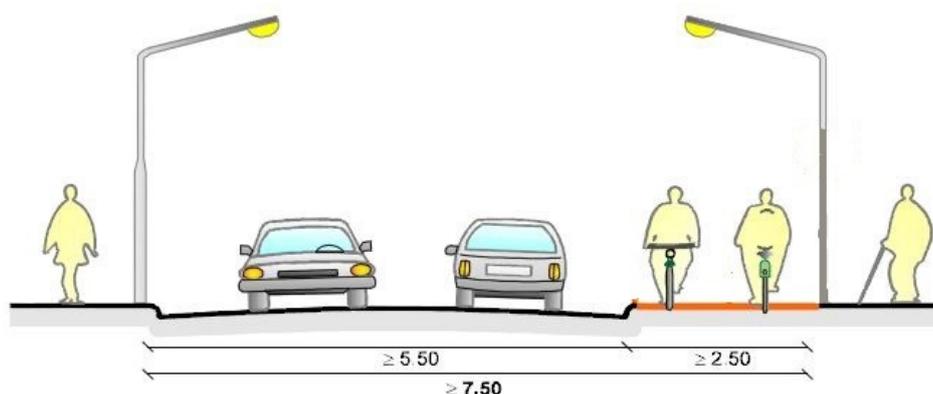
SCHEMA SEZIONE TIPO TRATTO 1
